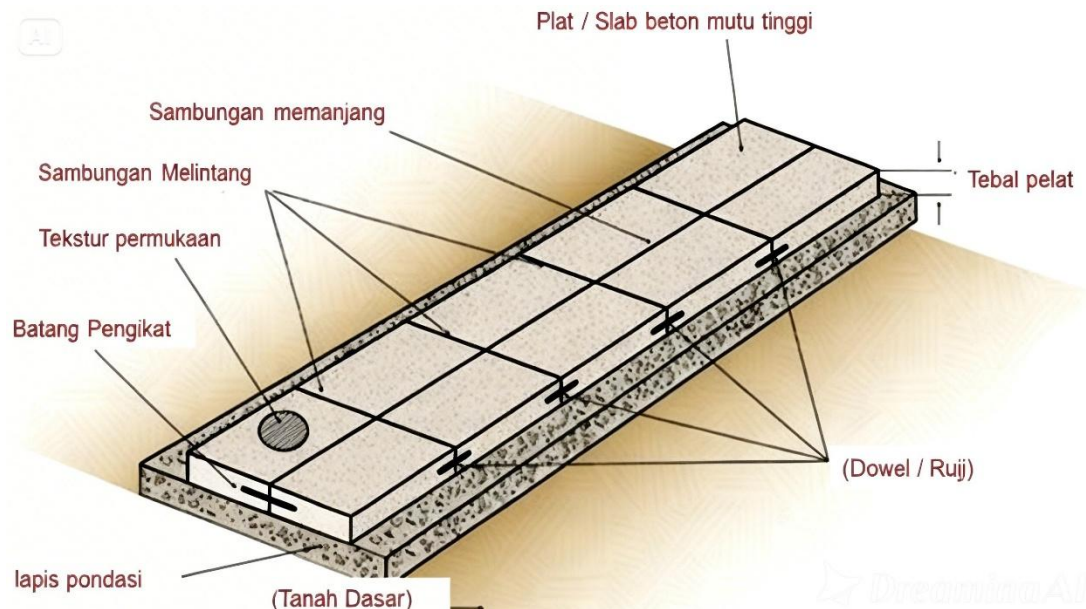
5 *Jointed Reinforced/Plan Concrete Pavement
